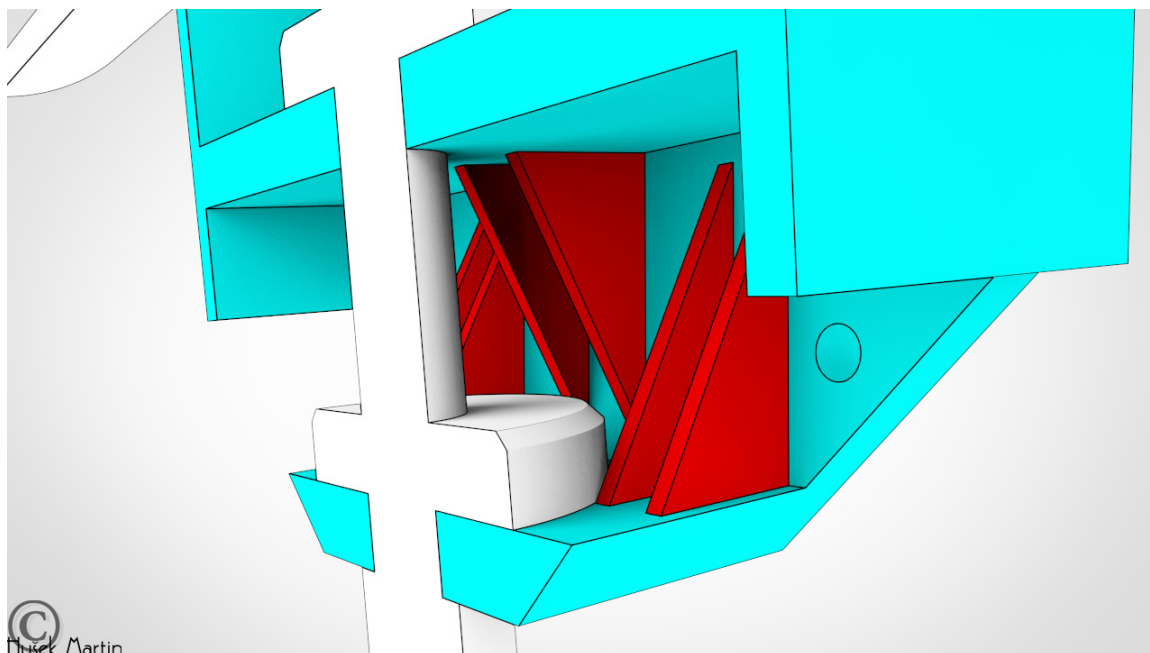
Nosná hlavice konstrukčního detailu napojení lan na konstrukci rámu.
